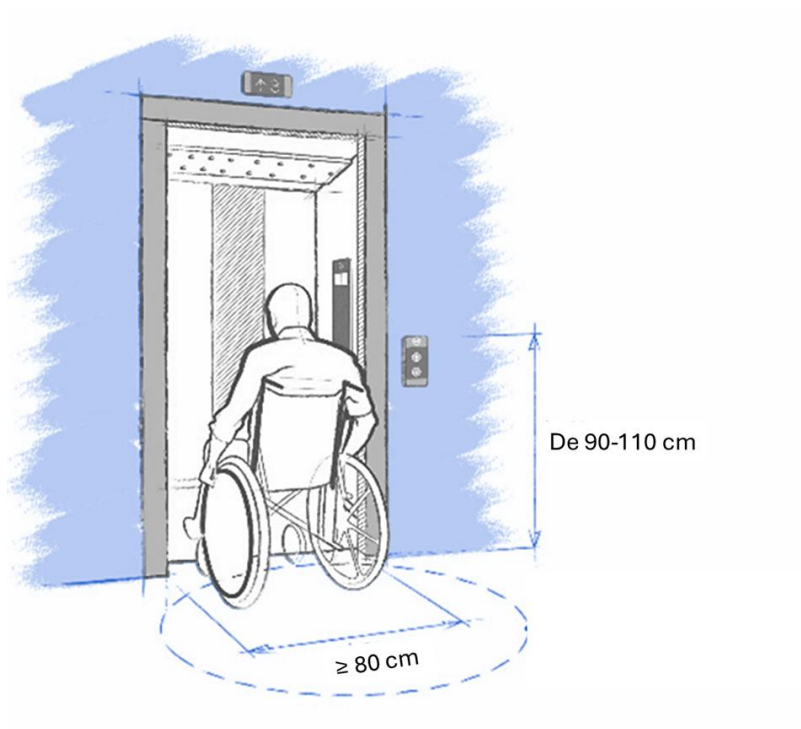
Dimensiones necesarias en acceso al elevador vertical.
